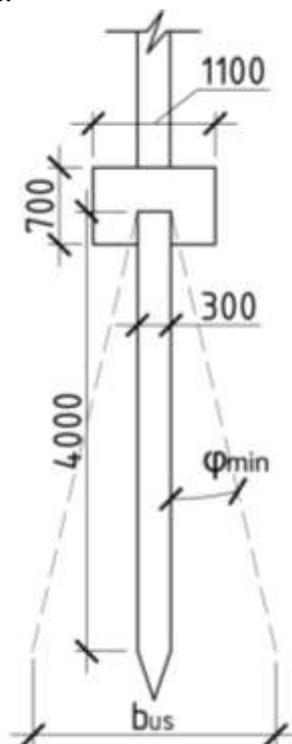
Расчетная схема для определения осадки свайного фундамента
